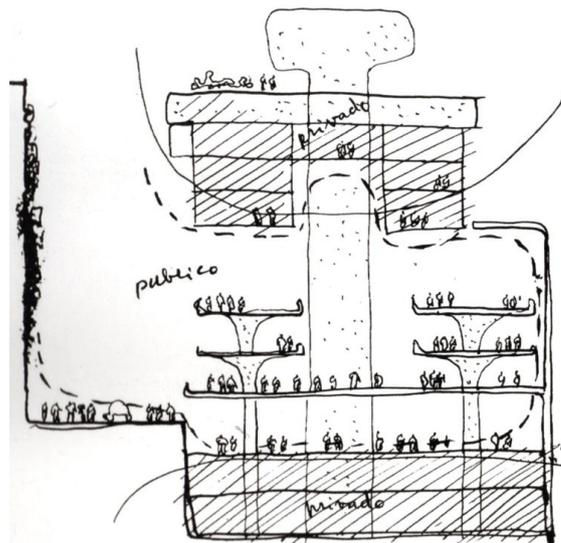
Croquis Banco central de Londres y América, Clorindo Testa, 1959
